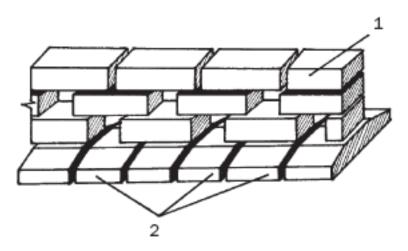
Ленточный фундамент с разрывами: 1 – фундаментные блоки; 2 – блоки подушки
